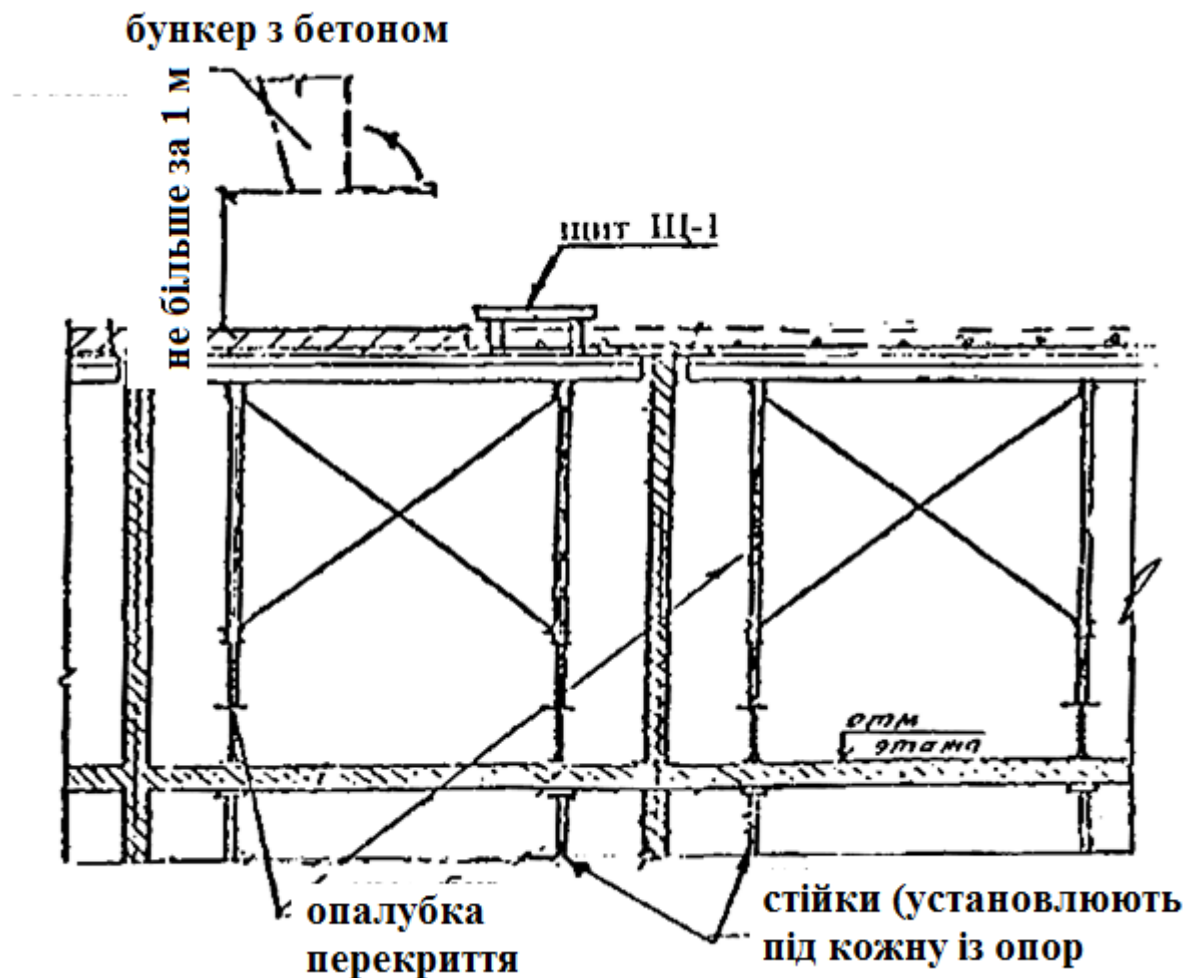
Вивантаження бетонної суміші з бункера у опалубку перекриття
